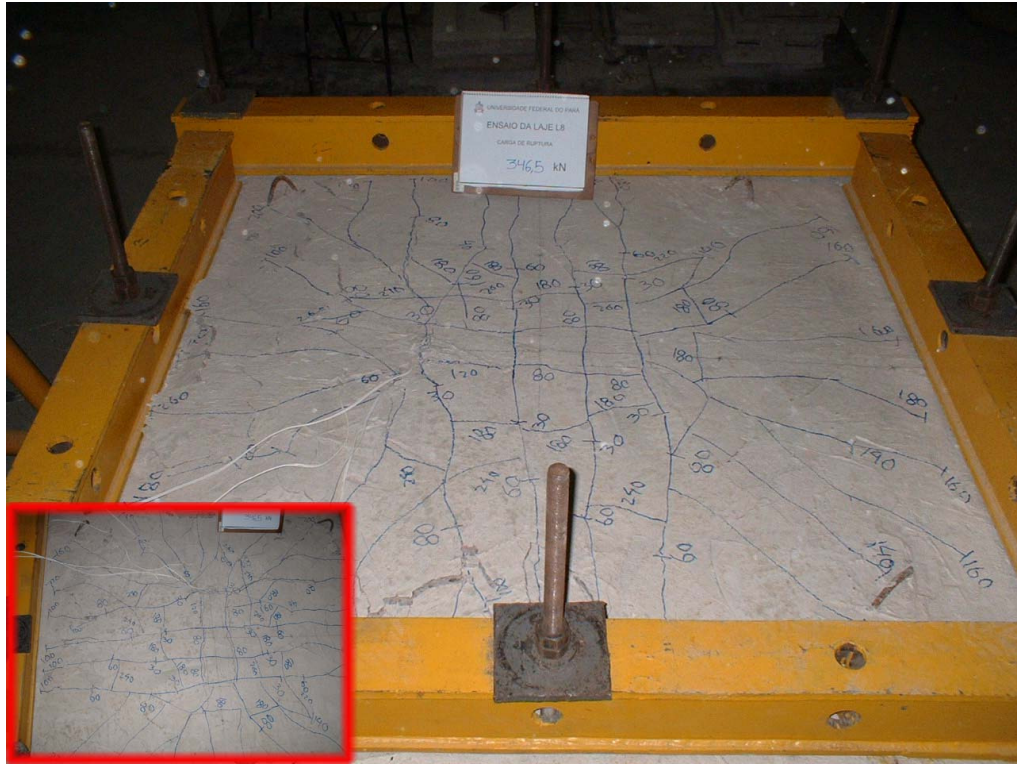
Fissuras desenvolvidas na face superior da laje L8
